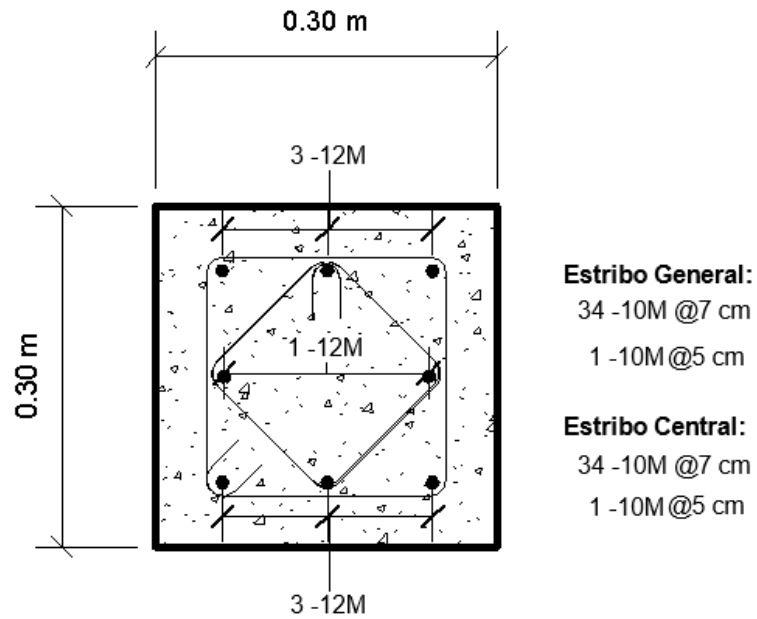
Sección transversal y acero de refuerzo colocada en la columna OMF del sistema de + pisos
